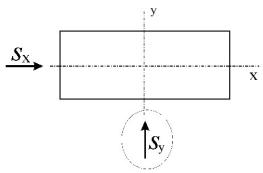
Схема действия сейсмических нагрузок на здание.
